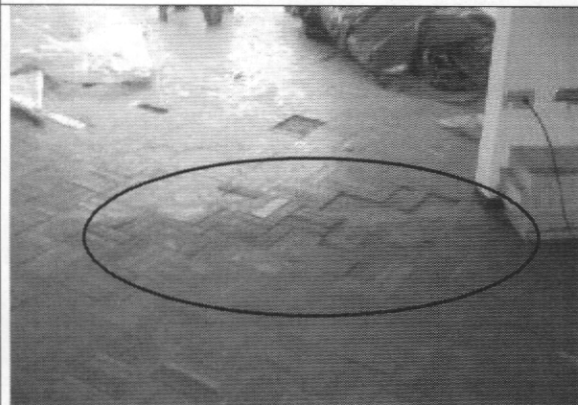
Acabado en madera de piso tercer nivel en mal estado, fisura en placa
